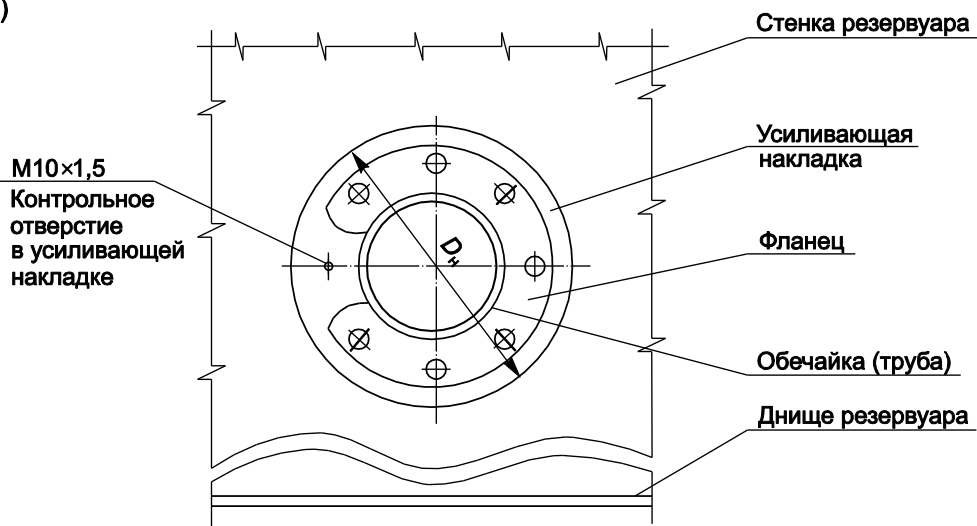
, лист 1 — Установка патрубков и люков в местах пересечения со сварными швами стенки (вертикальными или горизонтальными):
